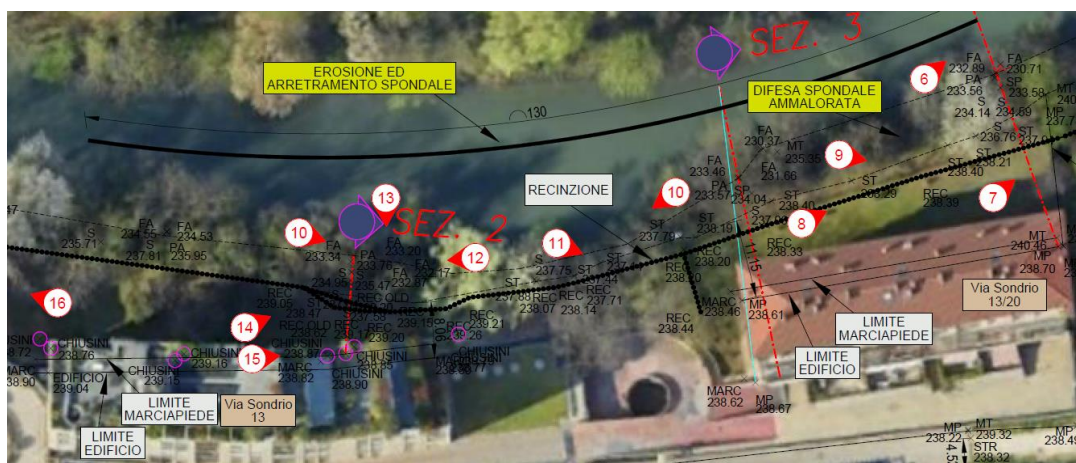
Estratto della Tavola D02 – Planimetria di rilievo: dettaglio del punto più critico dell'erosione.
